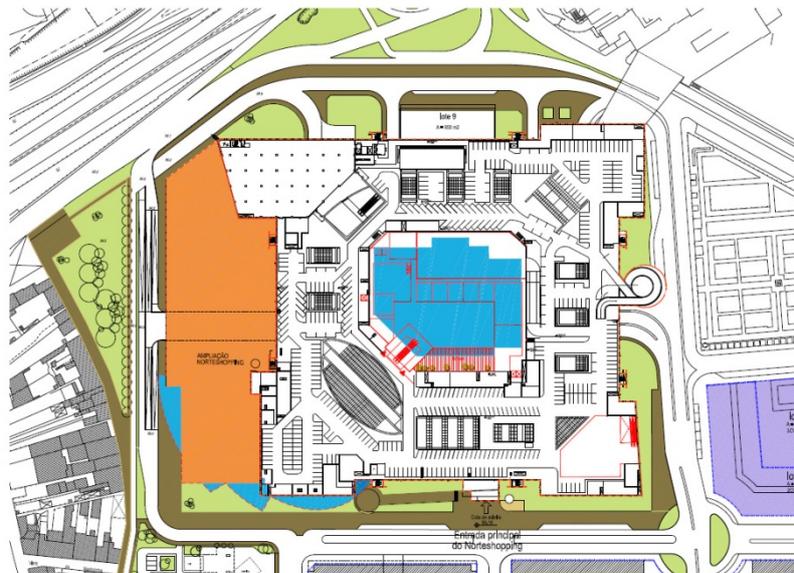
Layout do NorteShopping com a concretização do respetivo projeto de ampliação (área a laranja)
